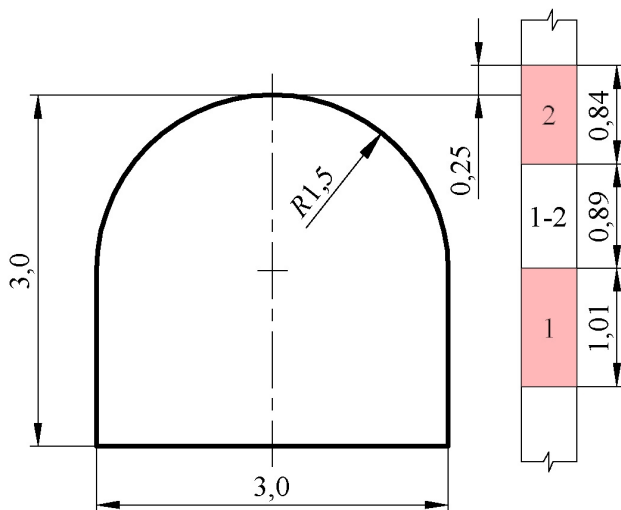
Привязка кровли выработки, пройденной комбайном типа ПКС-8М, ниже кровли 2-го слоя на 0,25 м
